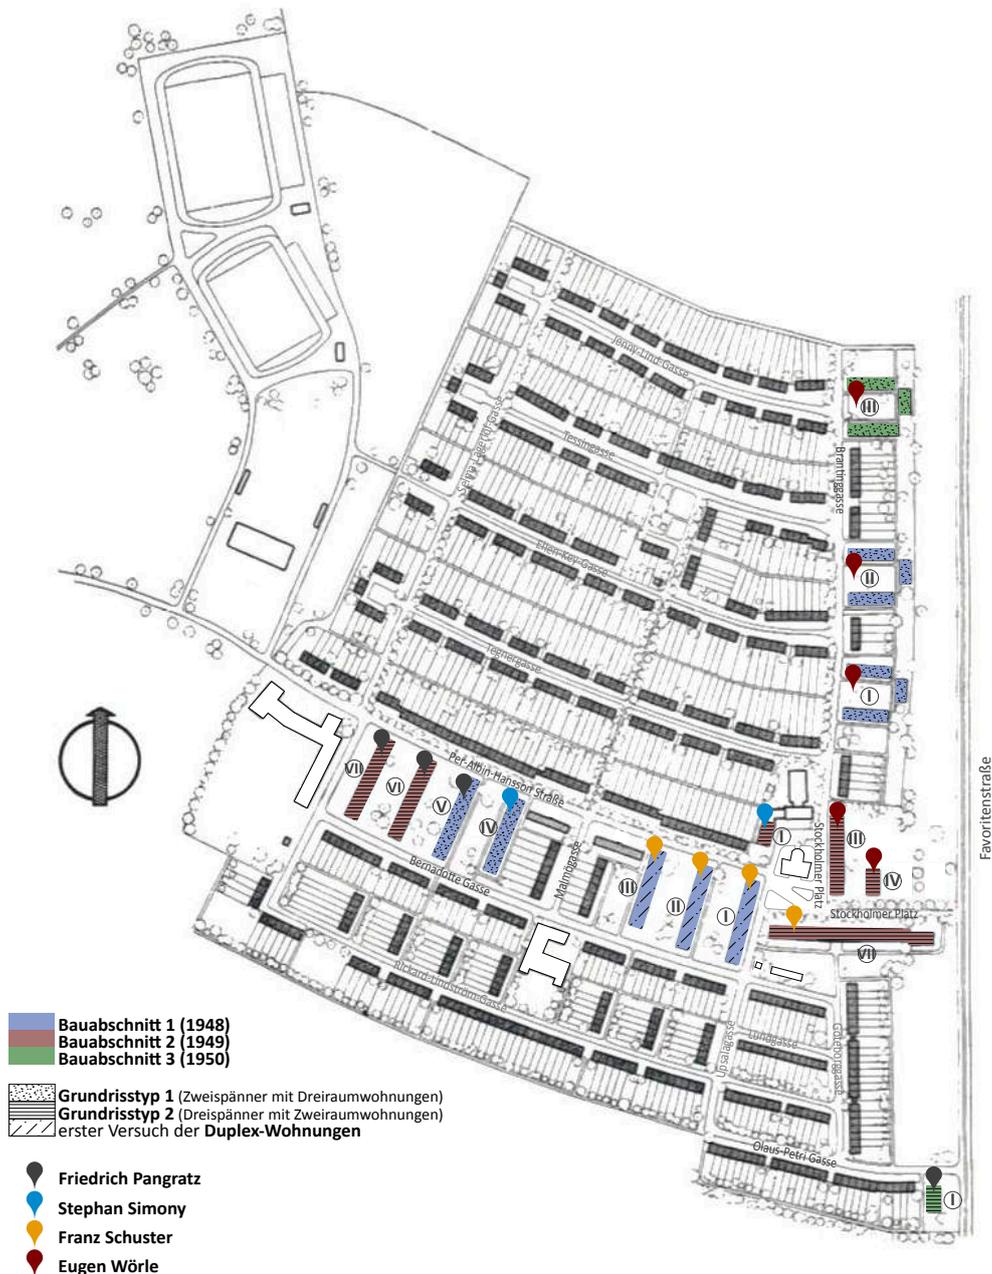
Bauabschnitte/ Grundrisstypen/ Zugehörige Architekten der Mehrfamilienhäuser in der Per-Albin-Hansson Siedlung West
